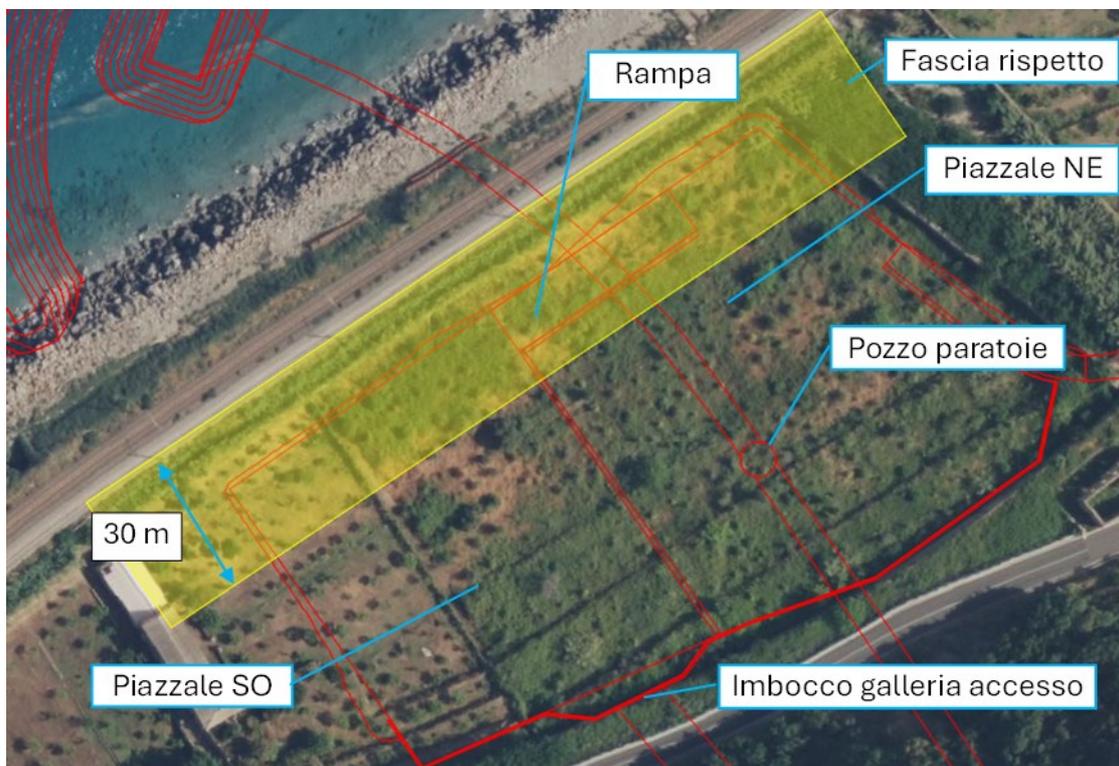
Fascia di rispetto della ferrovia (in giallo) sovrapposta al piazzale in progetto (in rosso)
